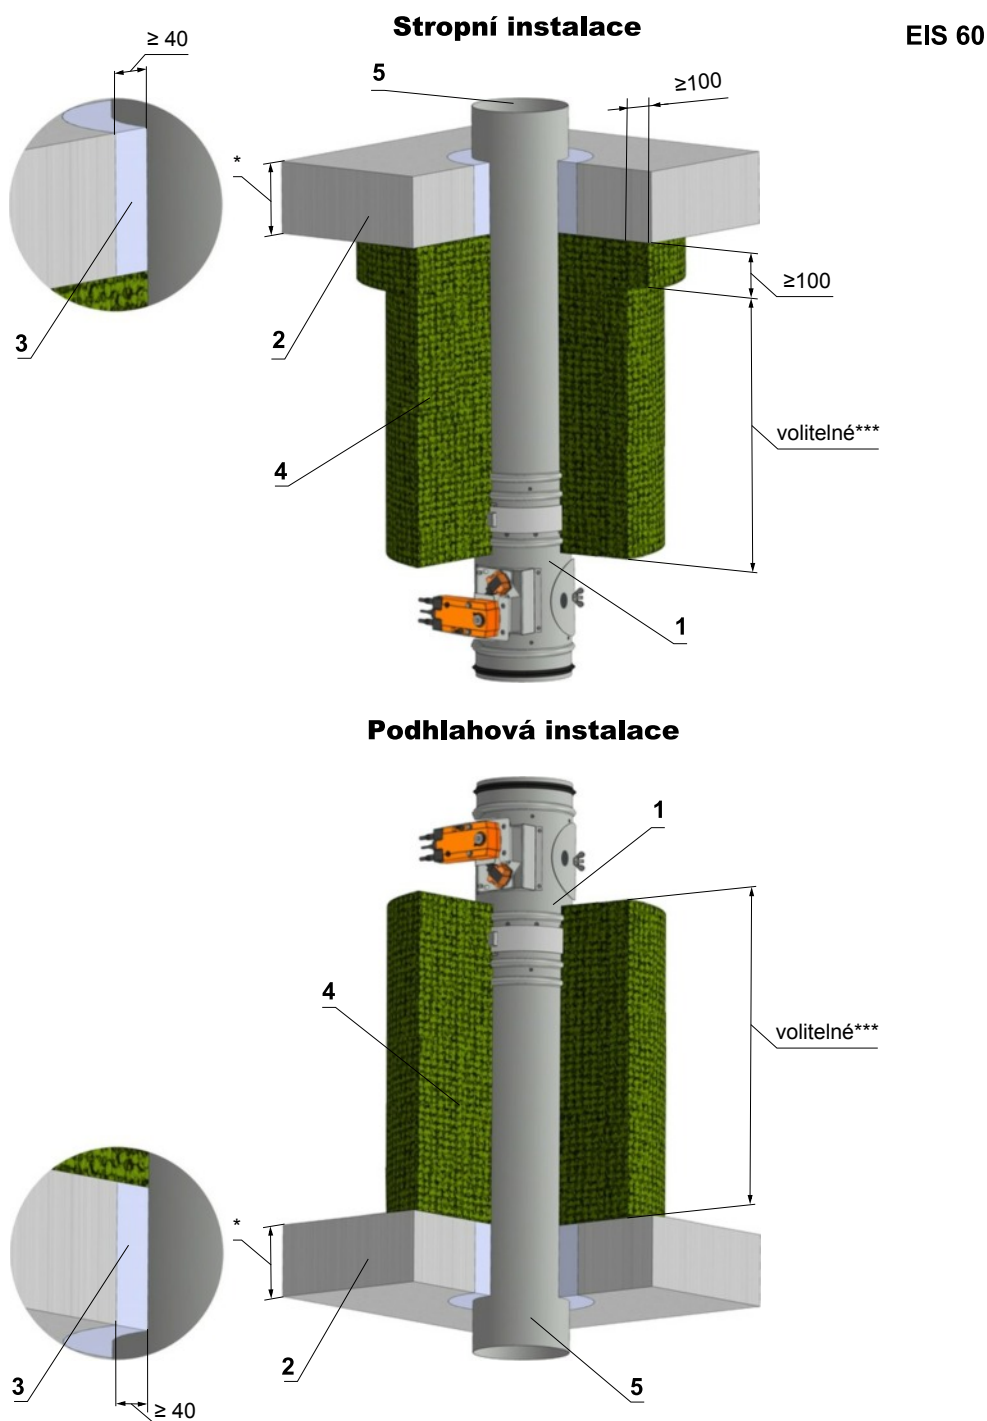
Tuhá stropní konstrukce - požární ucpávka se stěrkou
